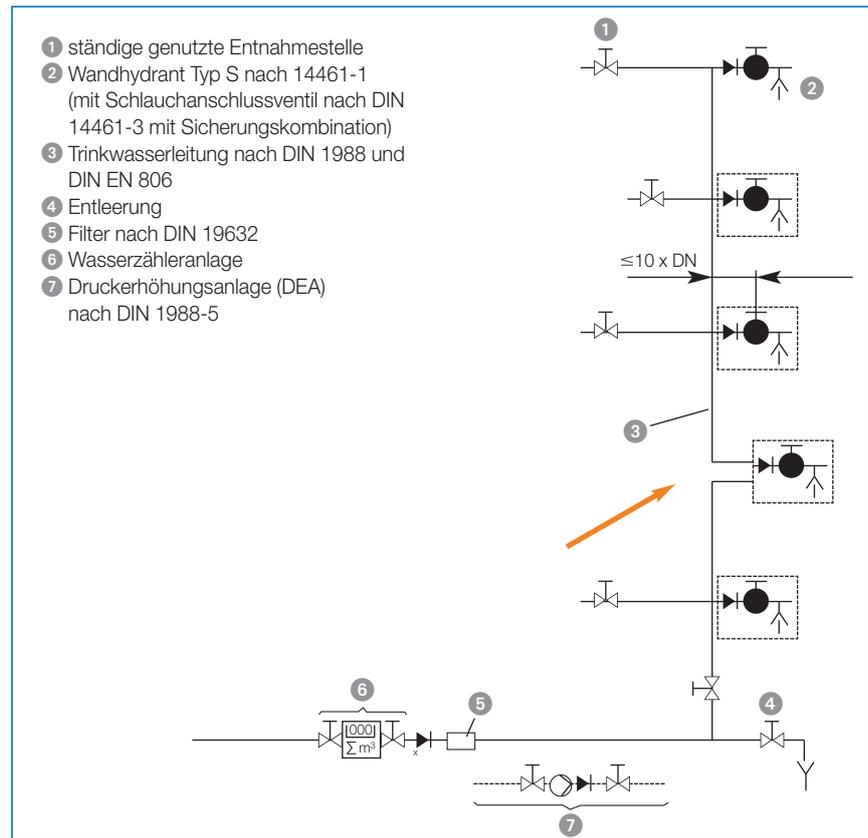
Trinkwasser-Installationen mit Wandhydranten Typ S (Selbsthilfe)
